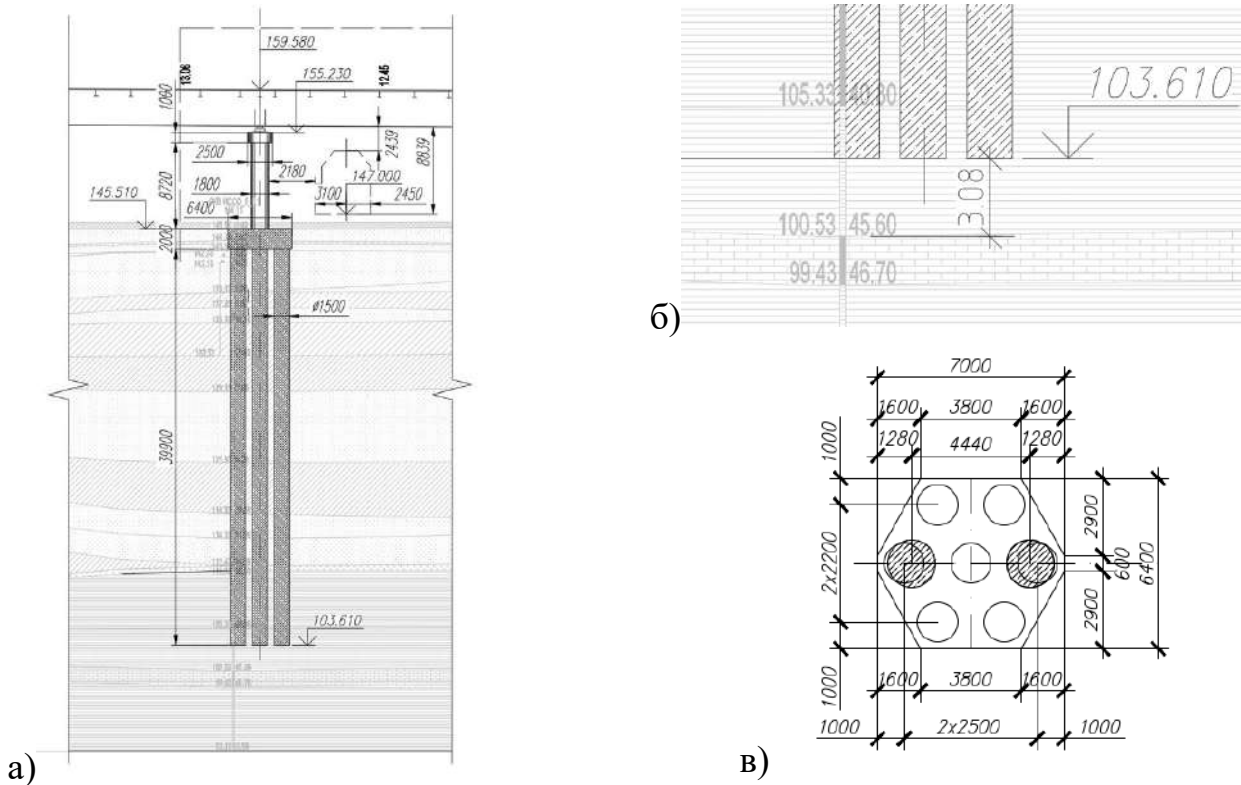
Фрагмент посадки опоры на инженерно-геологический разрез (а), расстояние от низа свай до кровли карстуемых грунтов (б) и план опоры (в)
